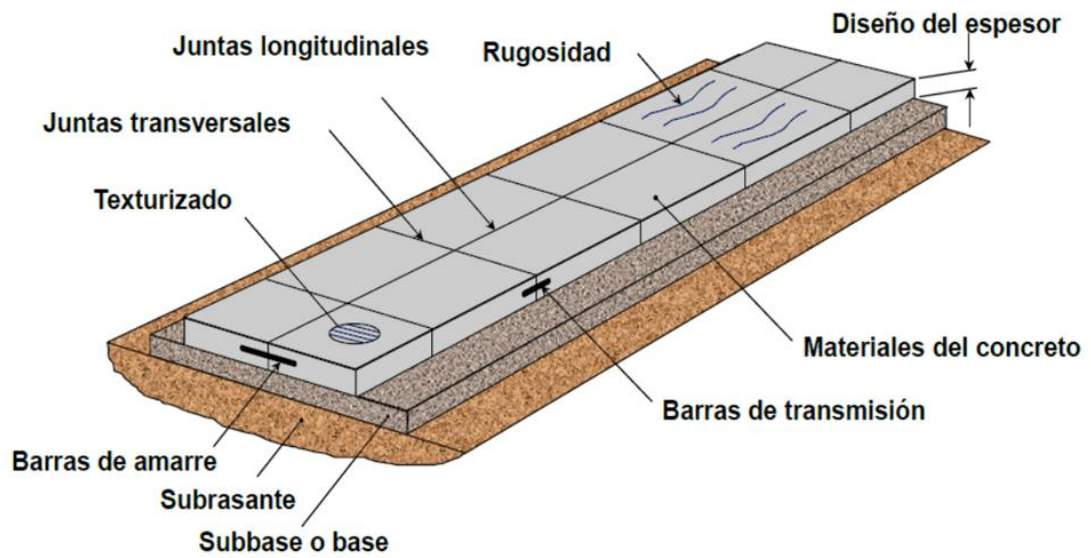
Elementos de un pavimento de concreto simple con pasadores.
